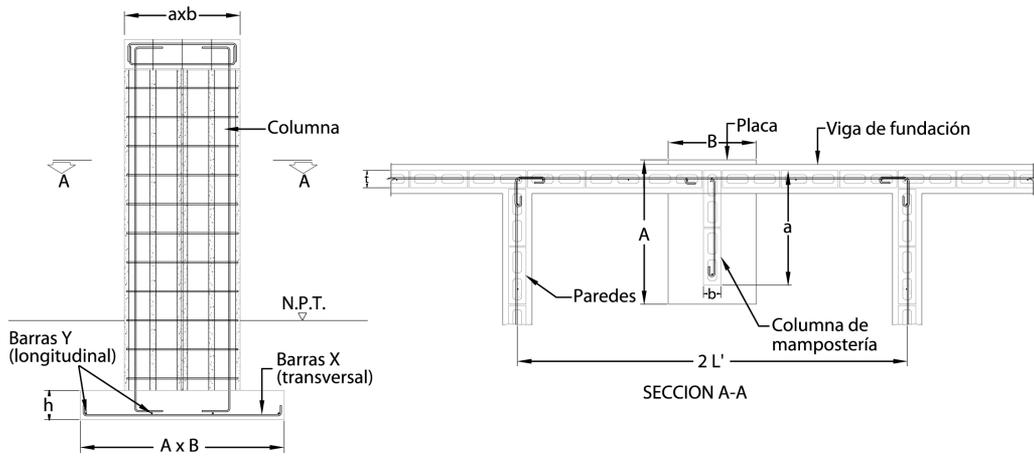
Detalle de columnas de mampostería con refuerzo integral.
